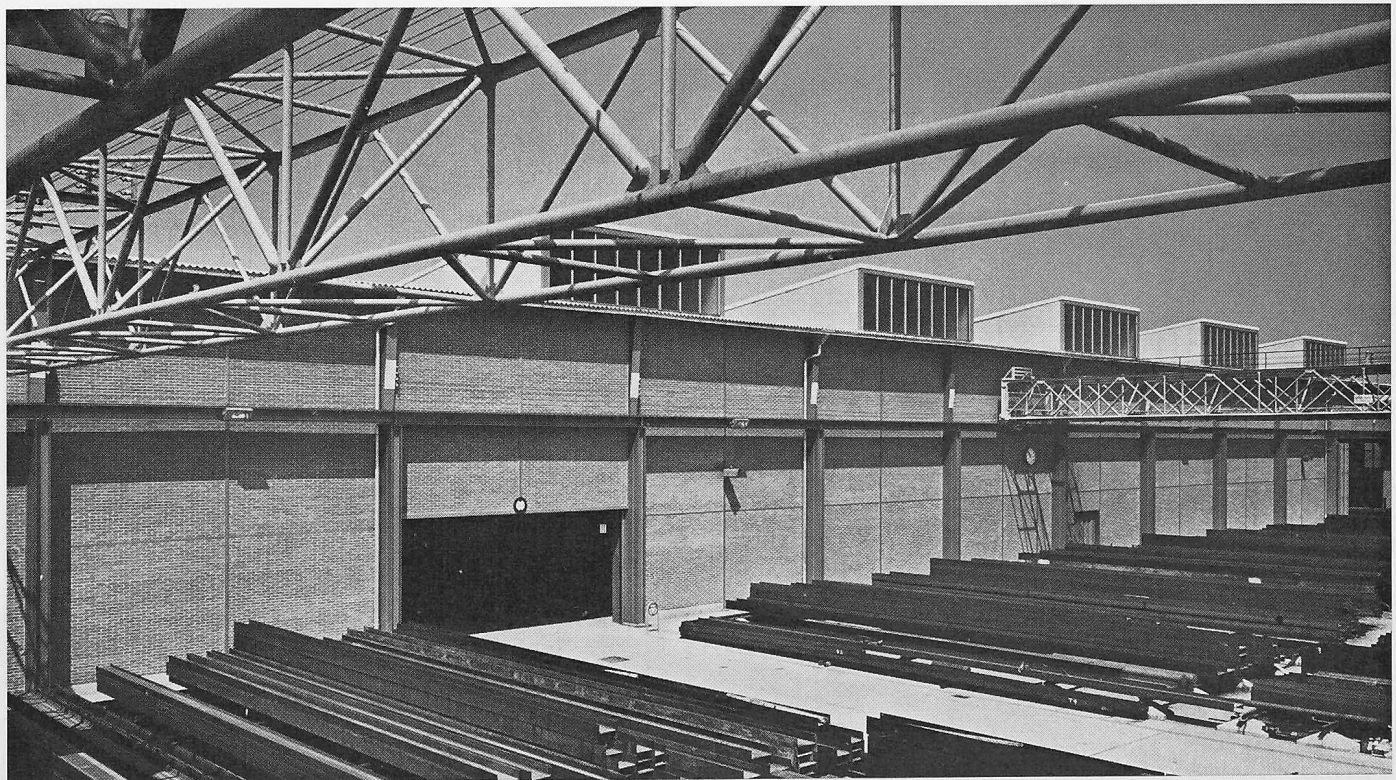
Ostfassade der Lagerhalle und offene Kranbahn mit Trägerlager. Im zweiten Feld von links Camioneneinfahrt mit Hubtor 8,7/3,8 m, im zehnten Feld Bahn-Ein- und Ausfahrt mit Faltschiebetor 11,0/6,5 m. Im Vordergrund Laufkran in geschweisster Rohrkonstruktion
